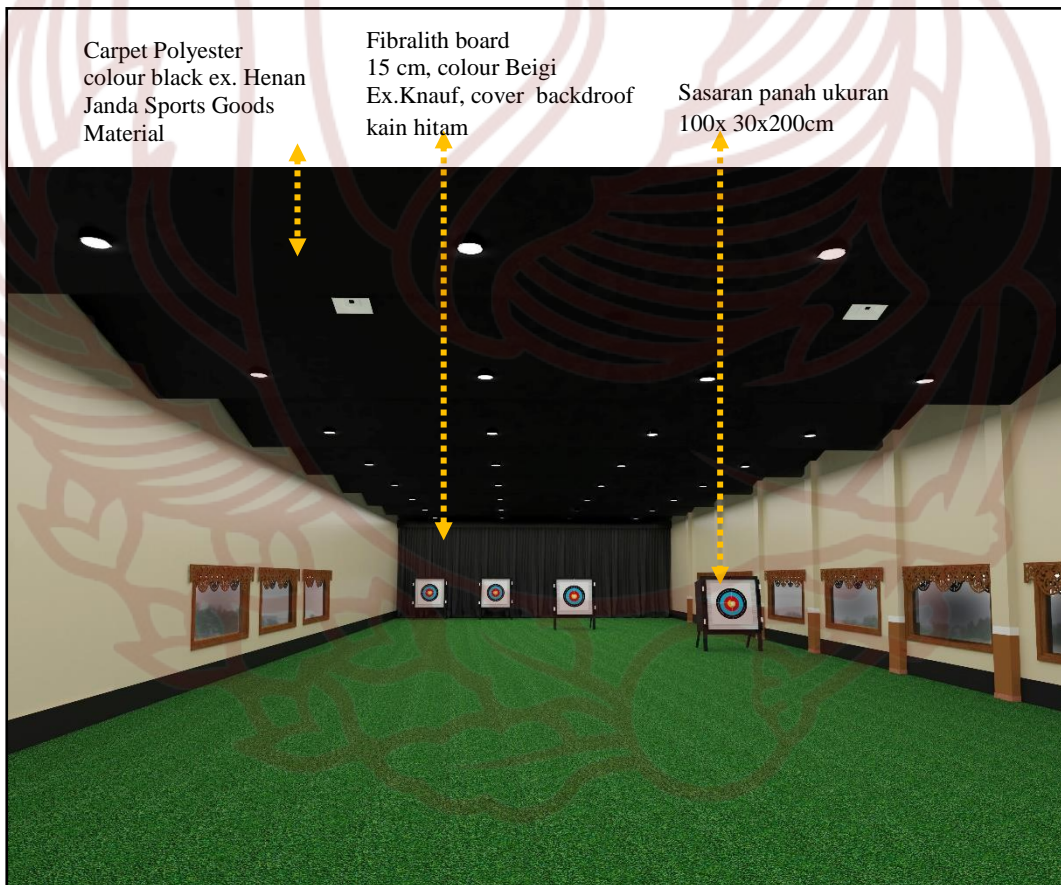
Hasil dan penerapan desain lantai ruang *in-door training
